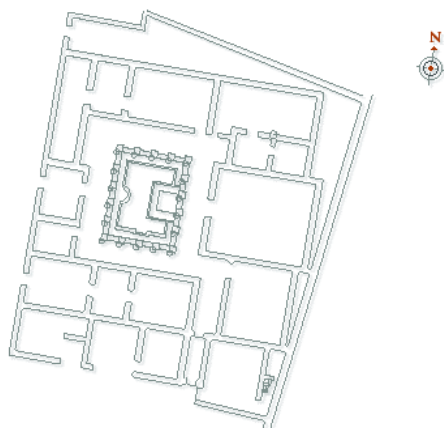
Planta da Casa dos Esqueletos de Conimbriga
